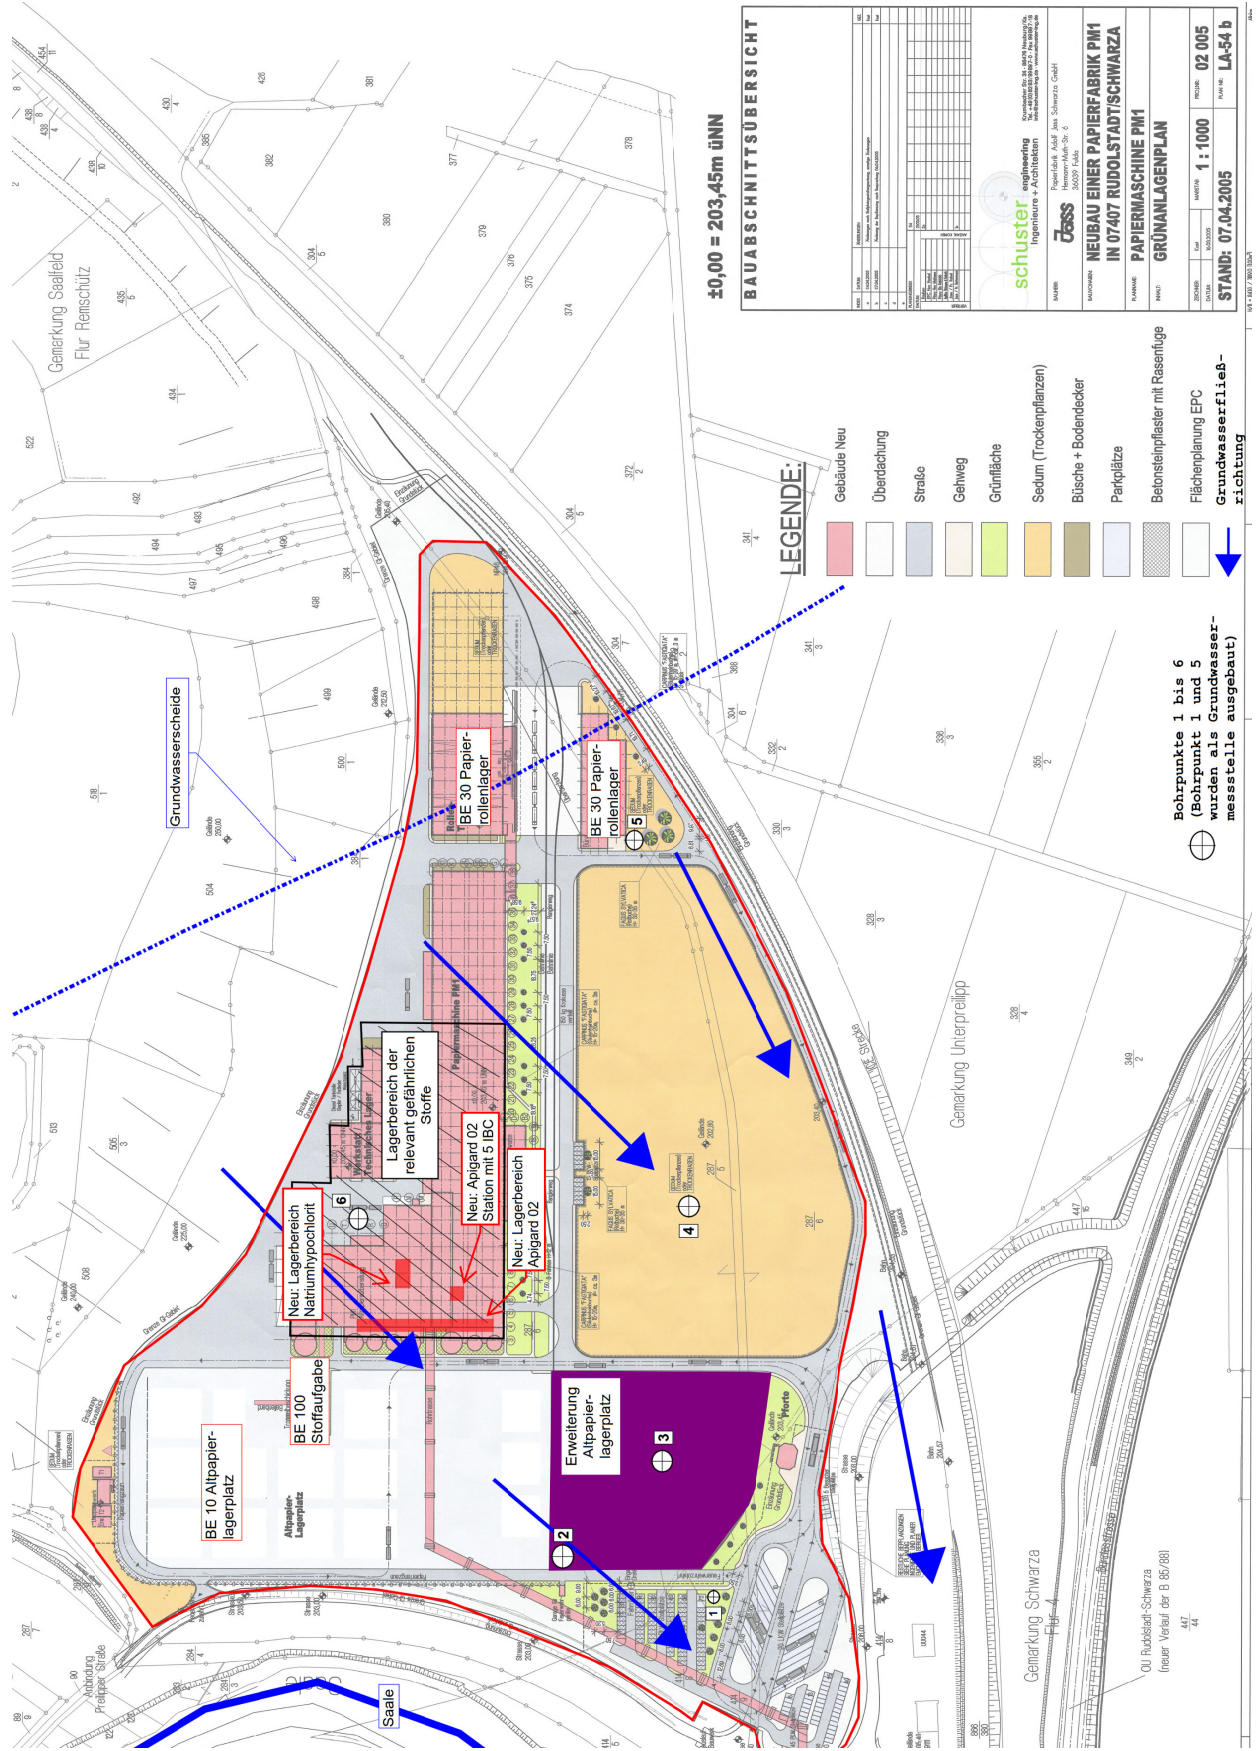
Lageplan mit Betriebseinheiten und Bohnpunkten und Grundwasserstandsstellen aus dem AZB Nr. 40/2018-5 zum GB 16/17 und Kennzeichnung der Lage der neuen Lager für Natriumhypochlorit und Apigard 02 (rot markiert)
